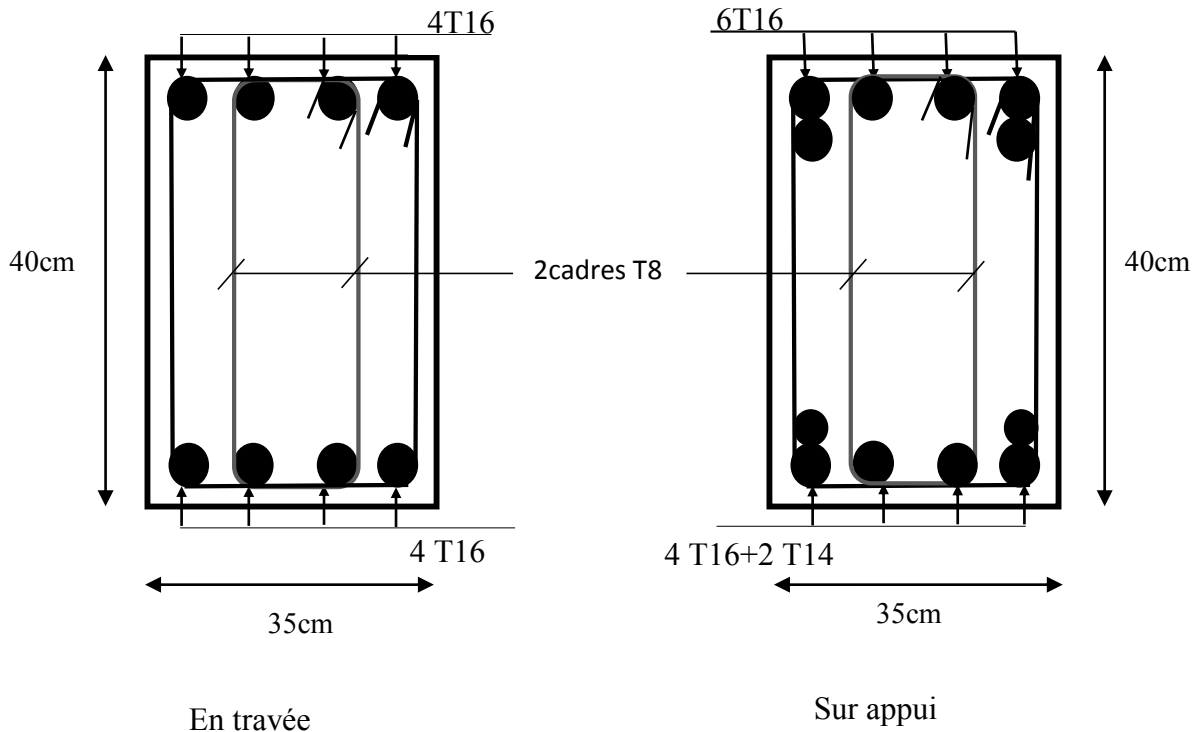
Schéma de Ferrailage des poutres principales.
